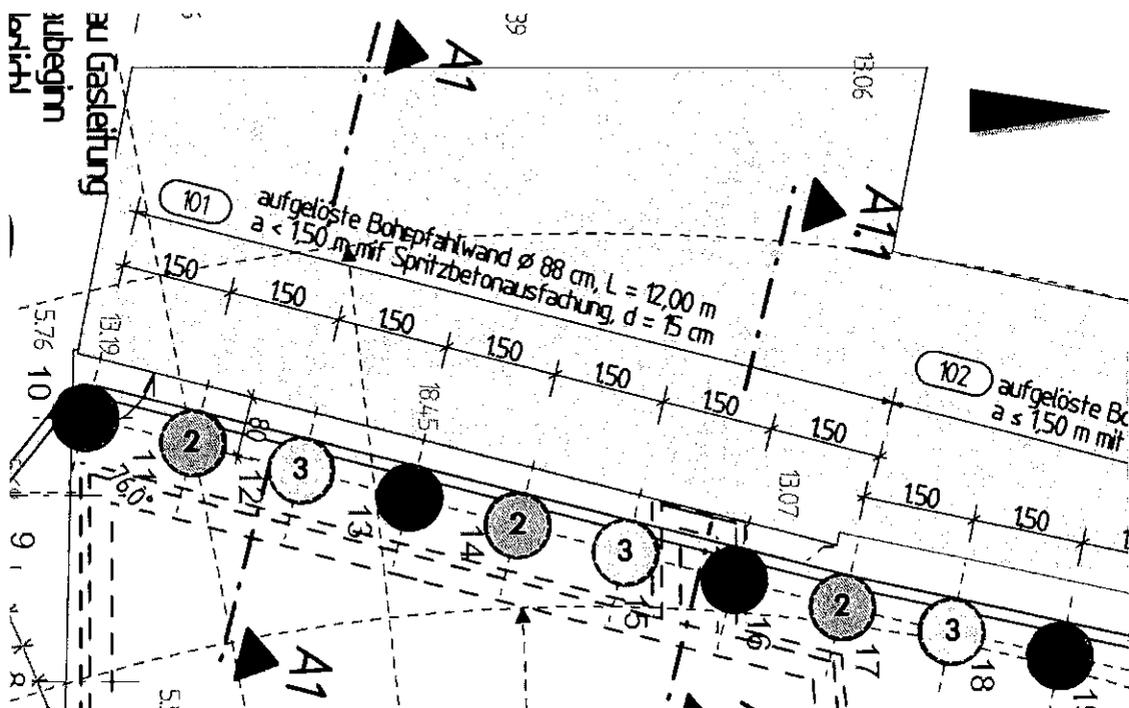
Empfohlener Ausführungsablauf der Kontaktbohrungen (Ausschnitt aus dem Baugrubenplan 500)
